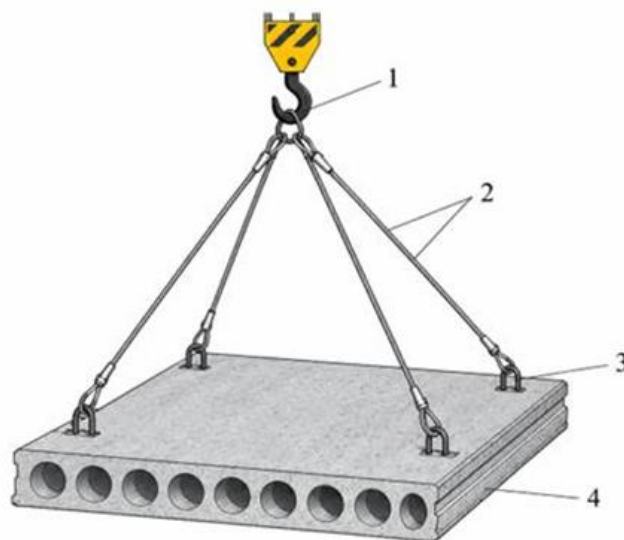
Схема стропування багатопустотної плити перекриття ПК 63.12-8
